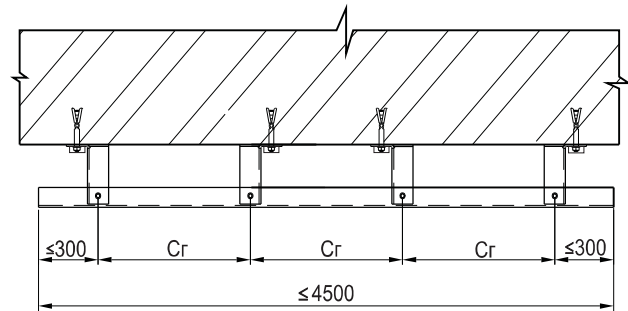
Принципиальная схема установки кронштейнов КР по вертикали. Крепление к мждуэтажному перекрытию.
